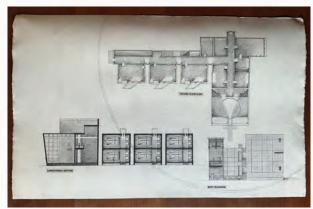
「学校建築」デザイン課題作品 2F平面配置図、断立面図
